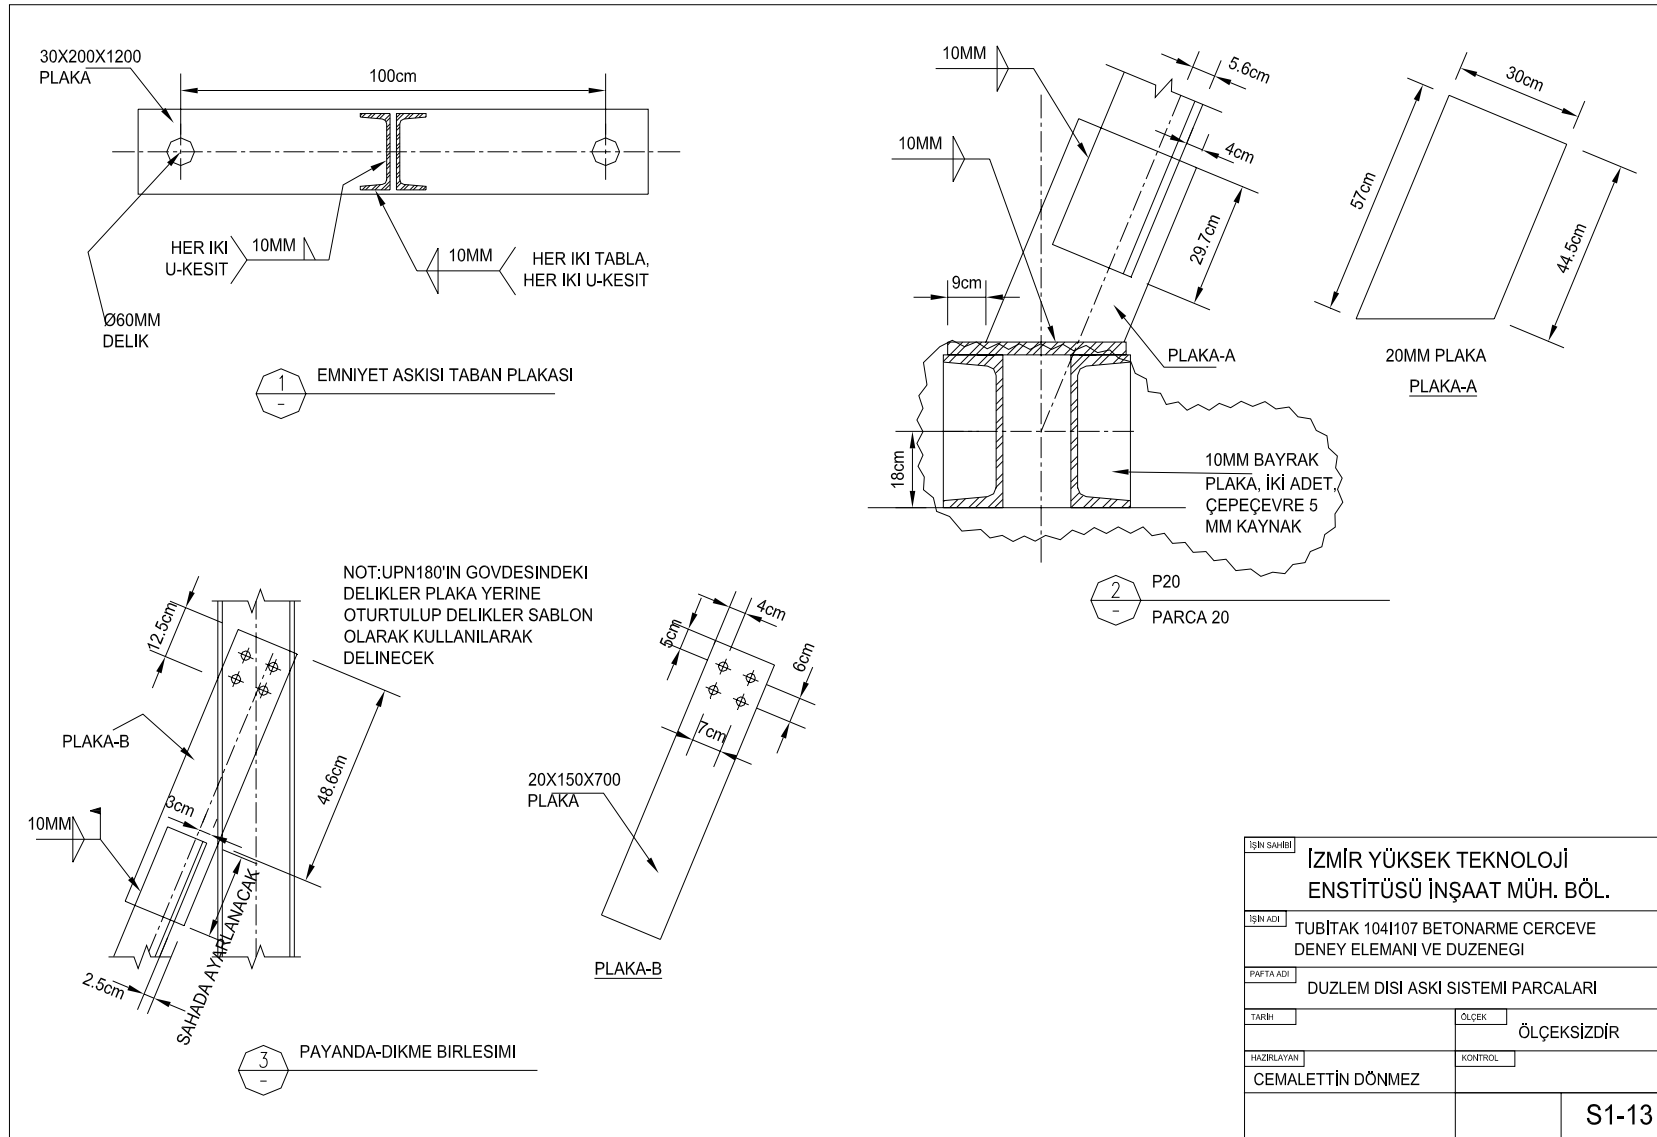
Betonarme çerçeve yükleme sistemi parçaları (devam)
